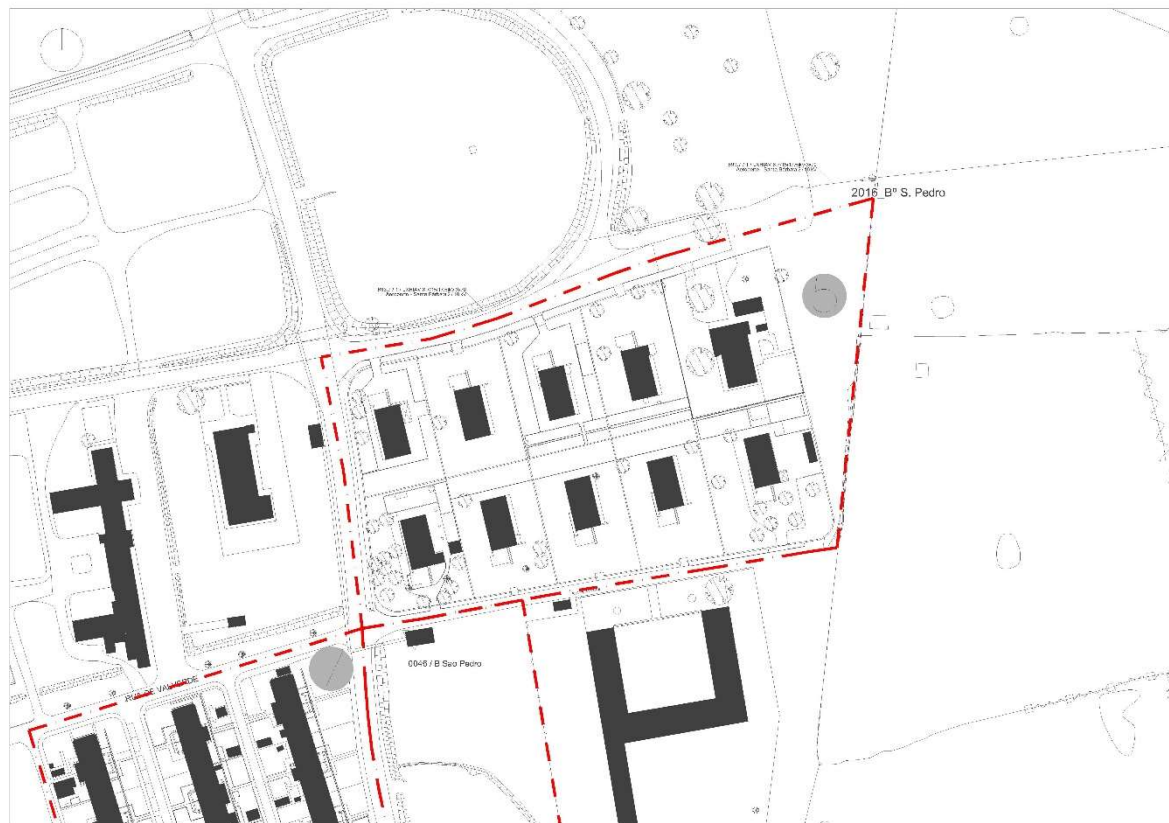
Planta do Bairro São Pedro (Extrato de Planta Cedida Pelas Ilhas de Valor)
